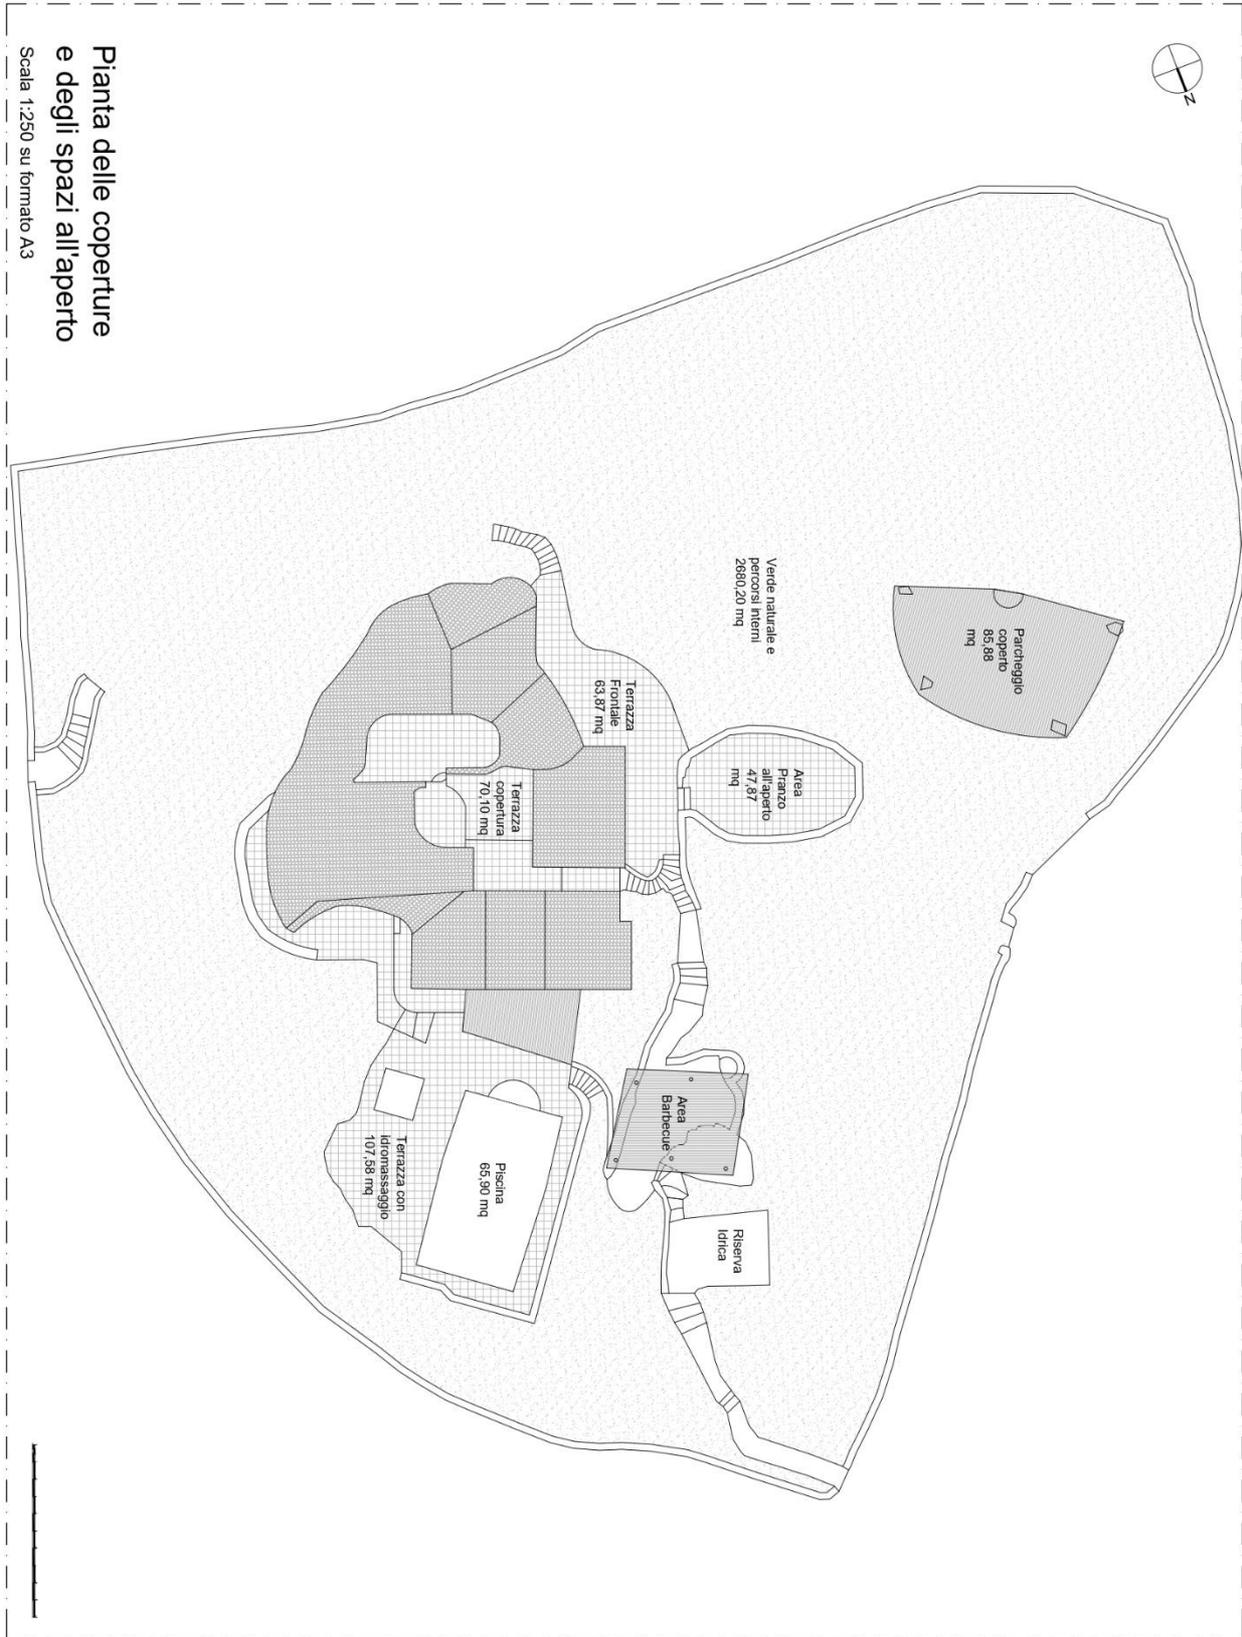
Planimetria dello stato di fatto – pianta perimetro proprietà con ambienti esterni
